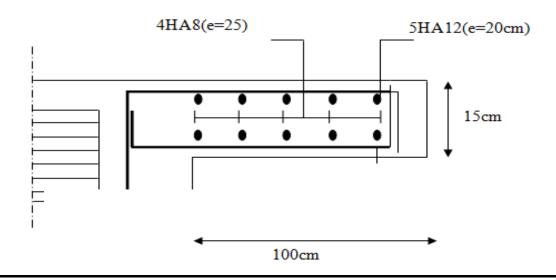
Ferraillage du balcon reposant sur deux appuis
